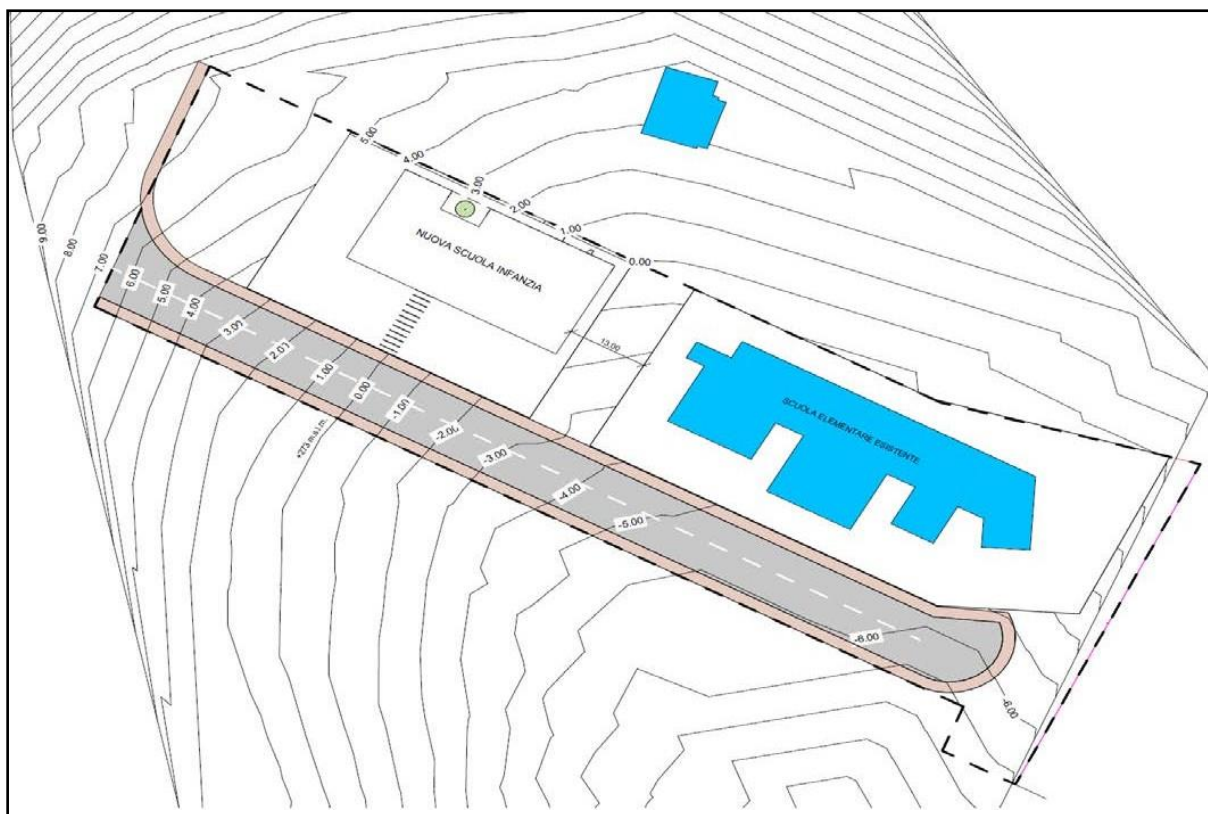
ESTRATTO PLANIMETRIA DI PROGETTO [FONTE: ENTE AFFIDANTE - PROGETTO DEFINITIVO]
